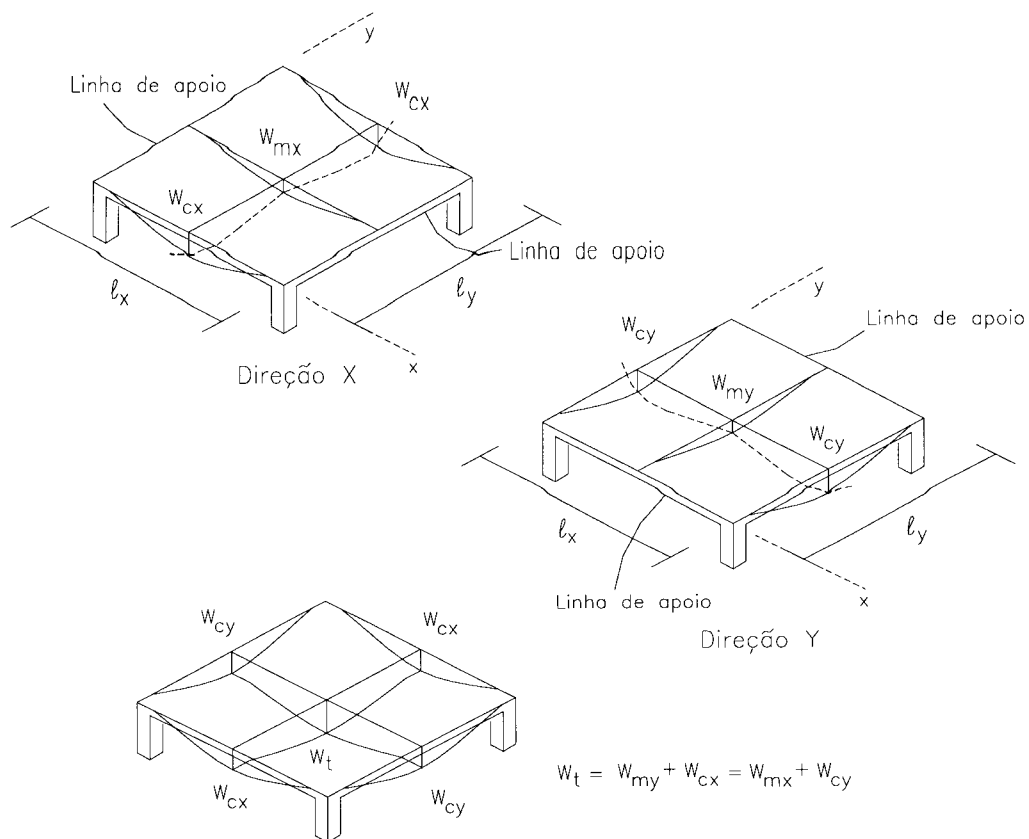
Esquema para cálculo do deslocamento no centro da laje [NILSON e WALTERS, 1975]
